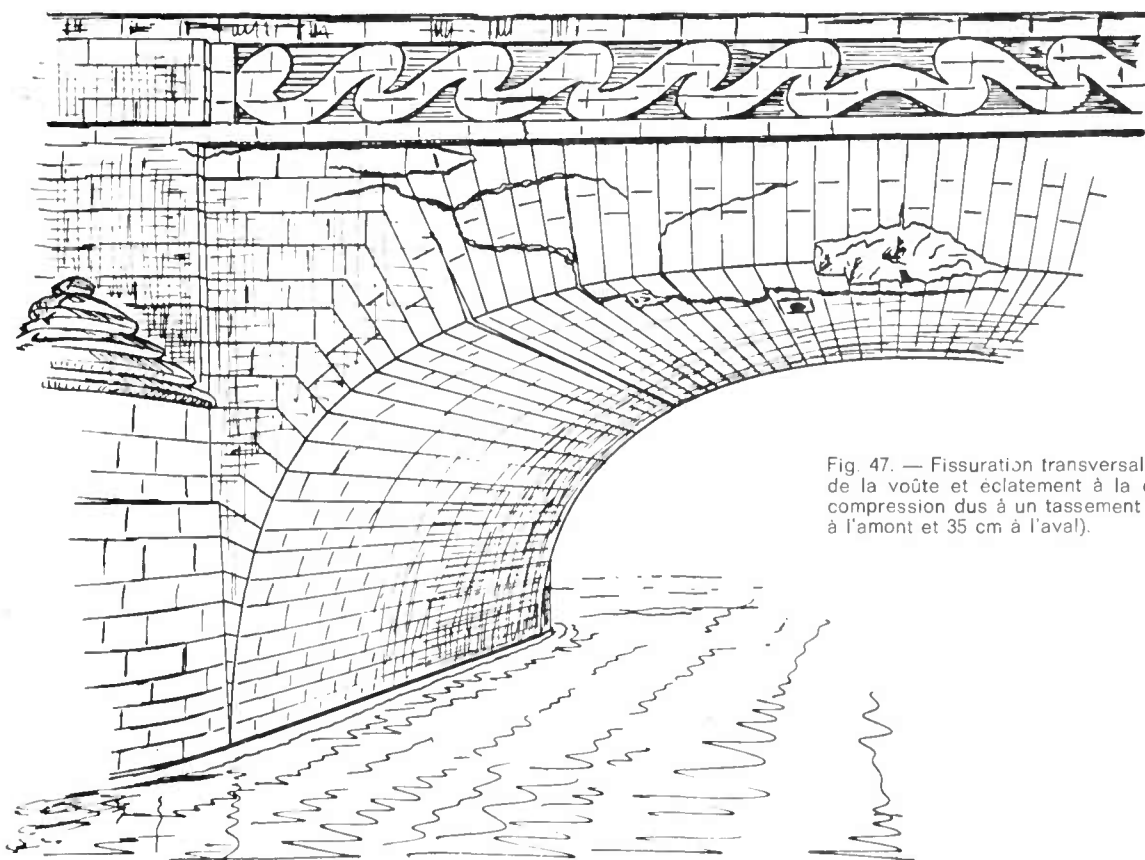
Fissuration transversale et longitudinale de la voûte et éclatement à la clé par excès de compression dus à un tassement de la pile (32 cm à l'amont et 35 cm à l'aval).
